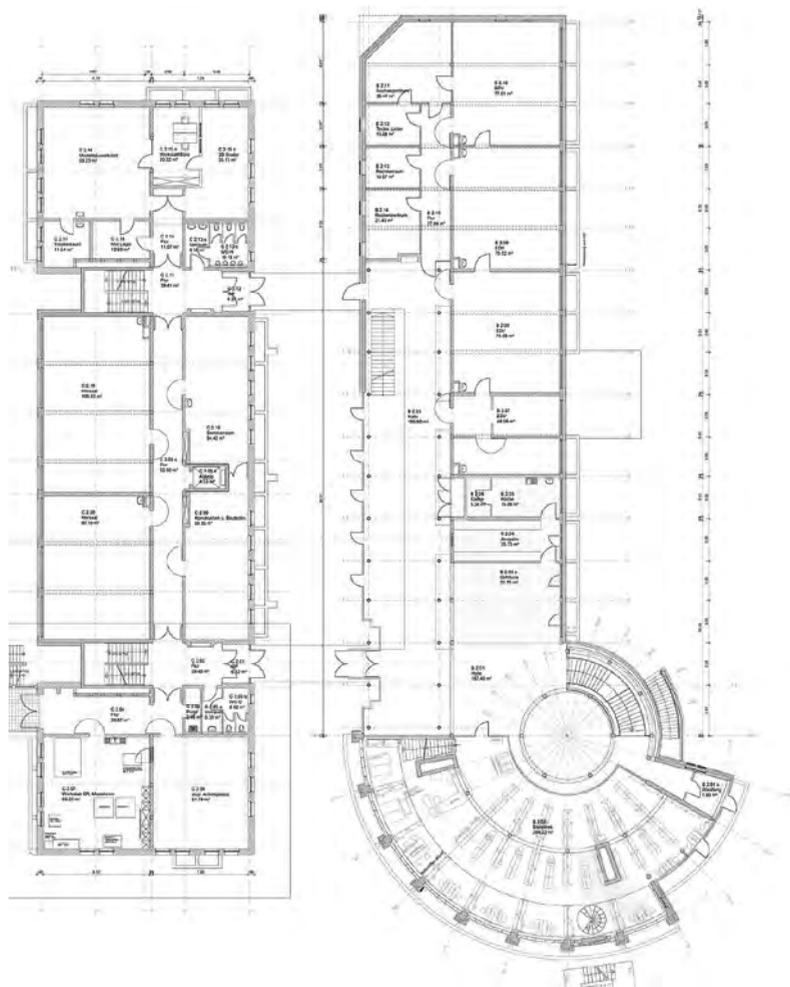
Grundriss EG, Gebäude B und C
